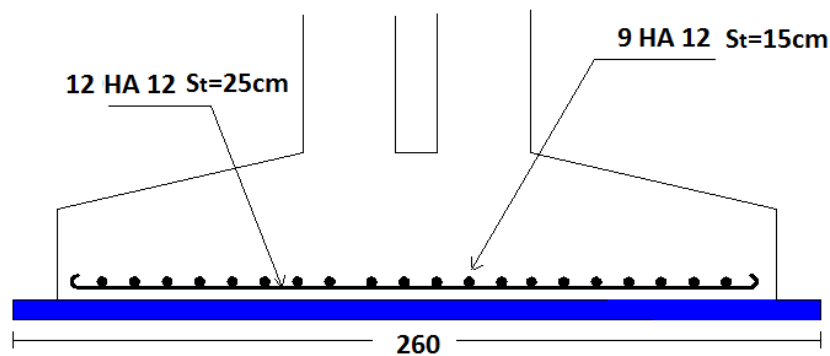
Schéma de ferrailage de la semelle type 2 (semelle jumelé).
